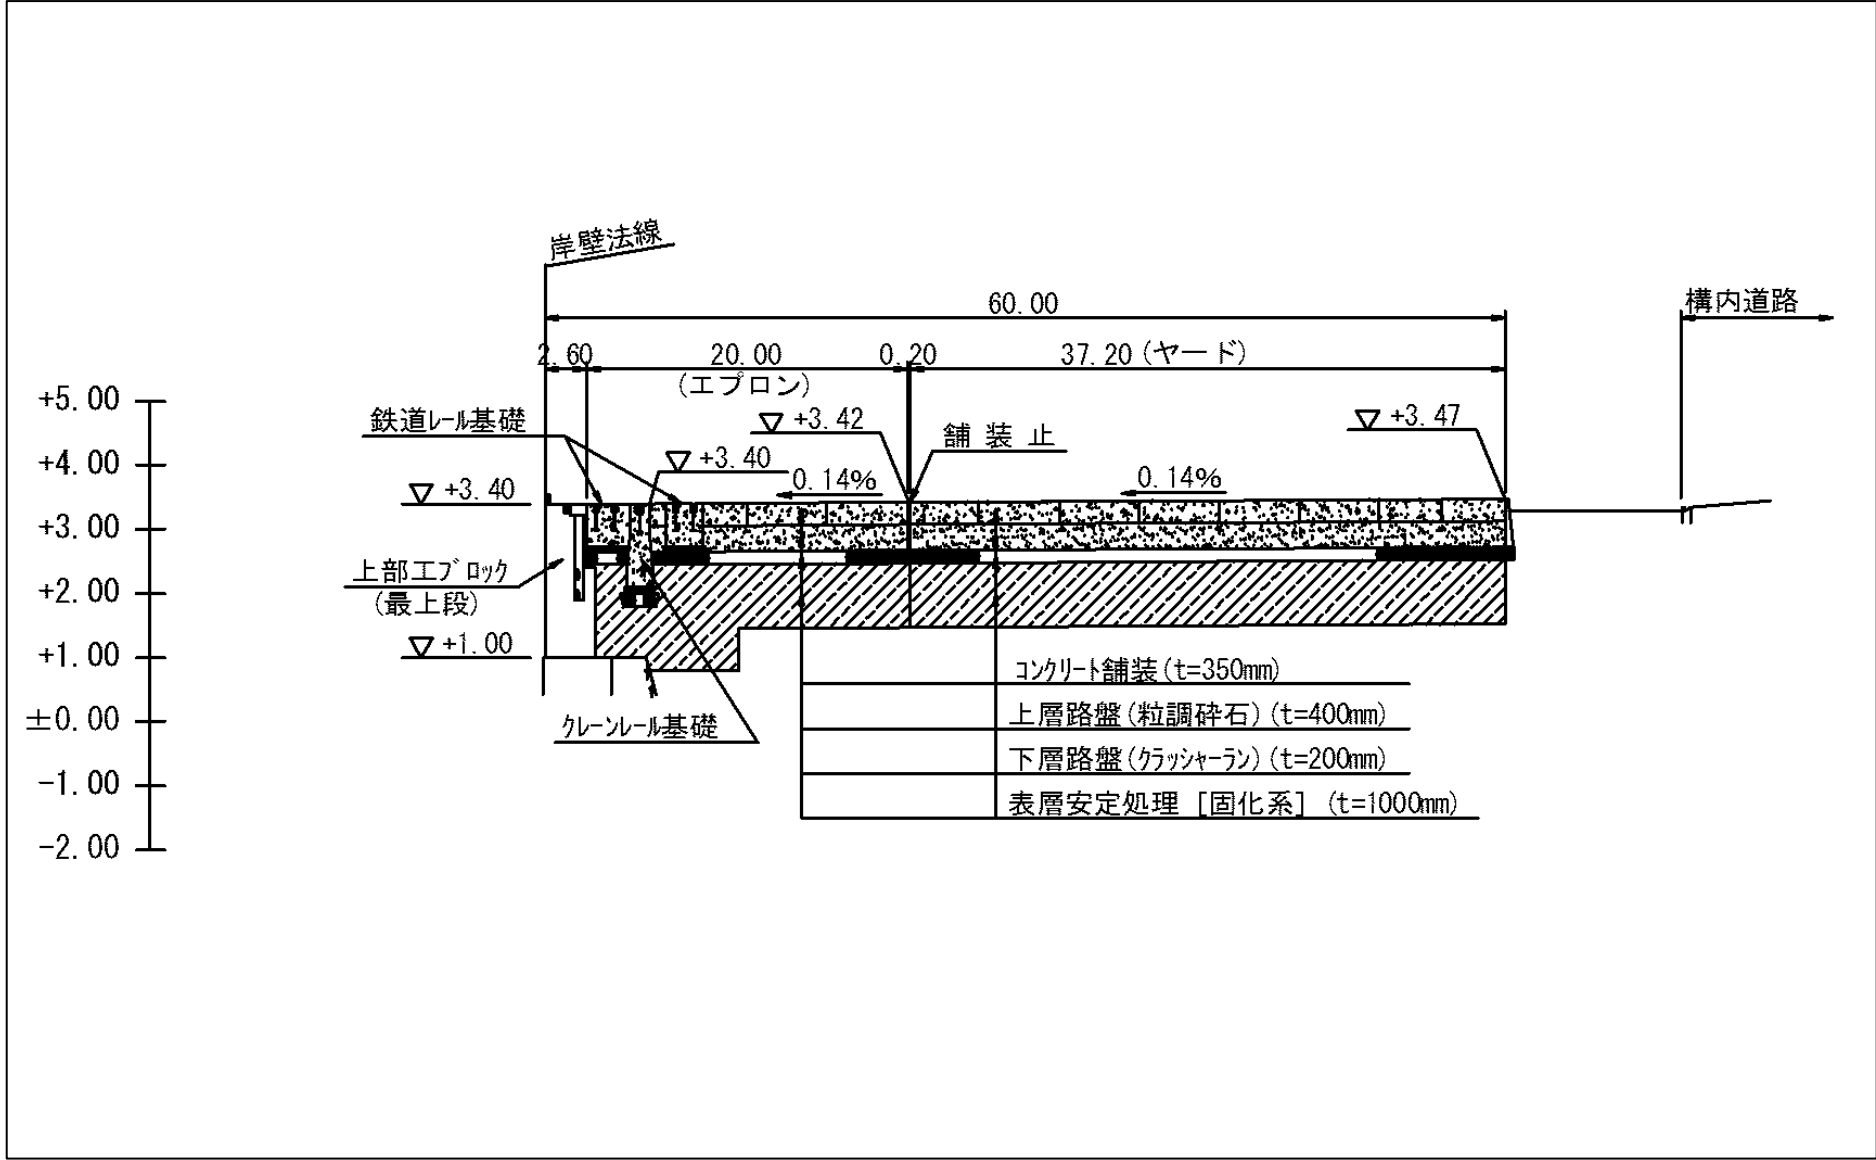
上部工、エプロン、ヤード全体横断面図
